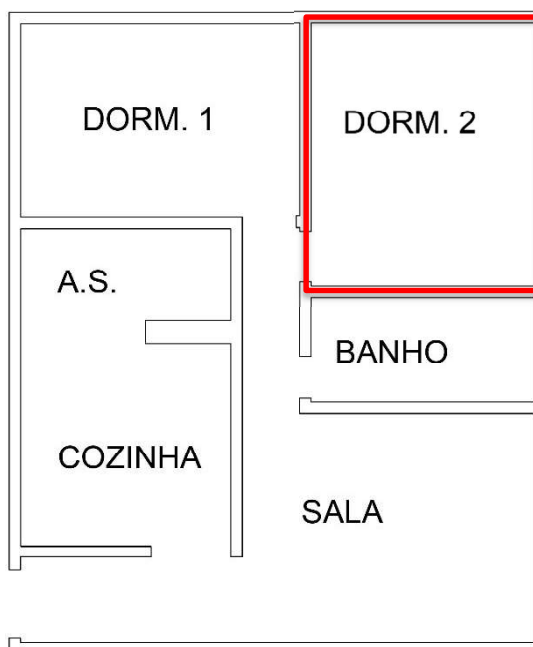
DORMITÓRIO 2, VISTA OPOSTA.
